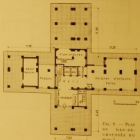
Plan du 1^{er} étage, construction en béton I.
